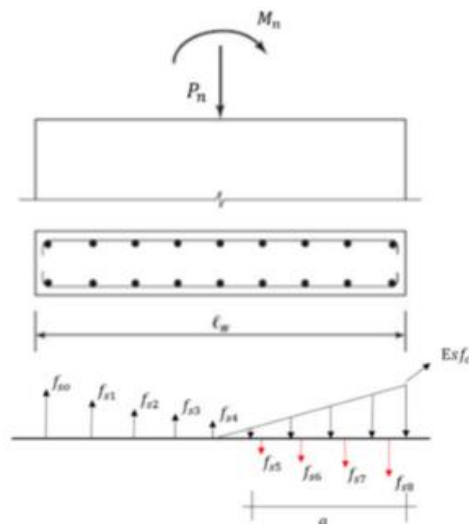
Esfuerzo de compresión para los sistemas de muro estructural
